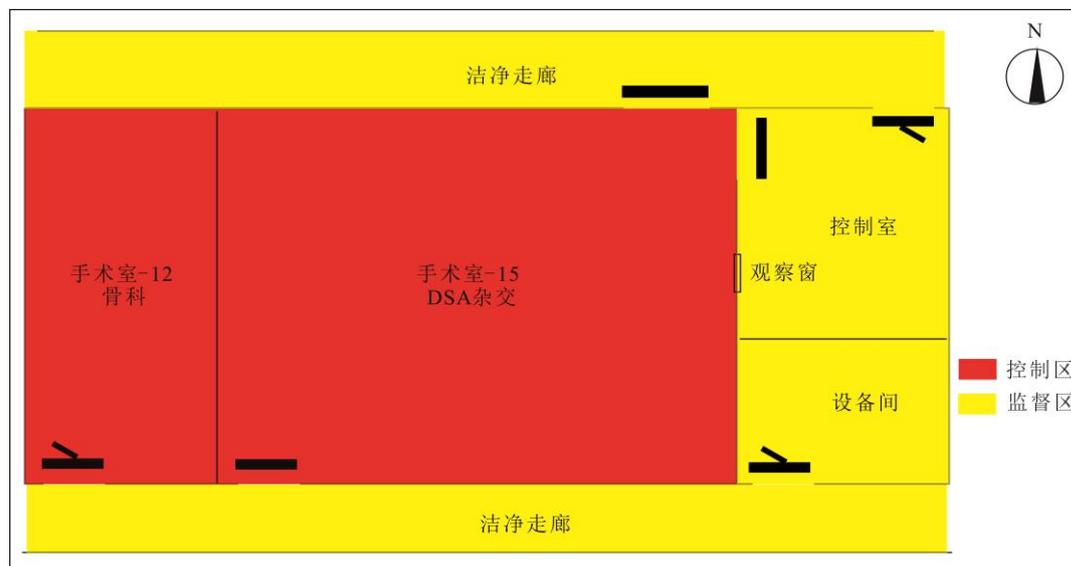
本项目 DSA 设备工作场所分区图-平面图
